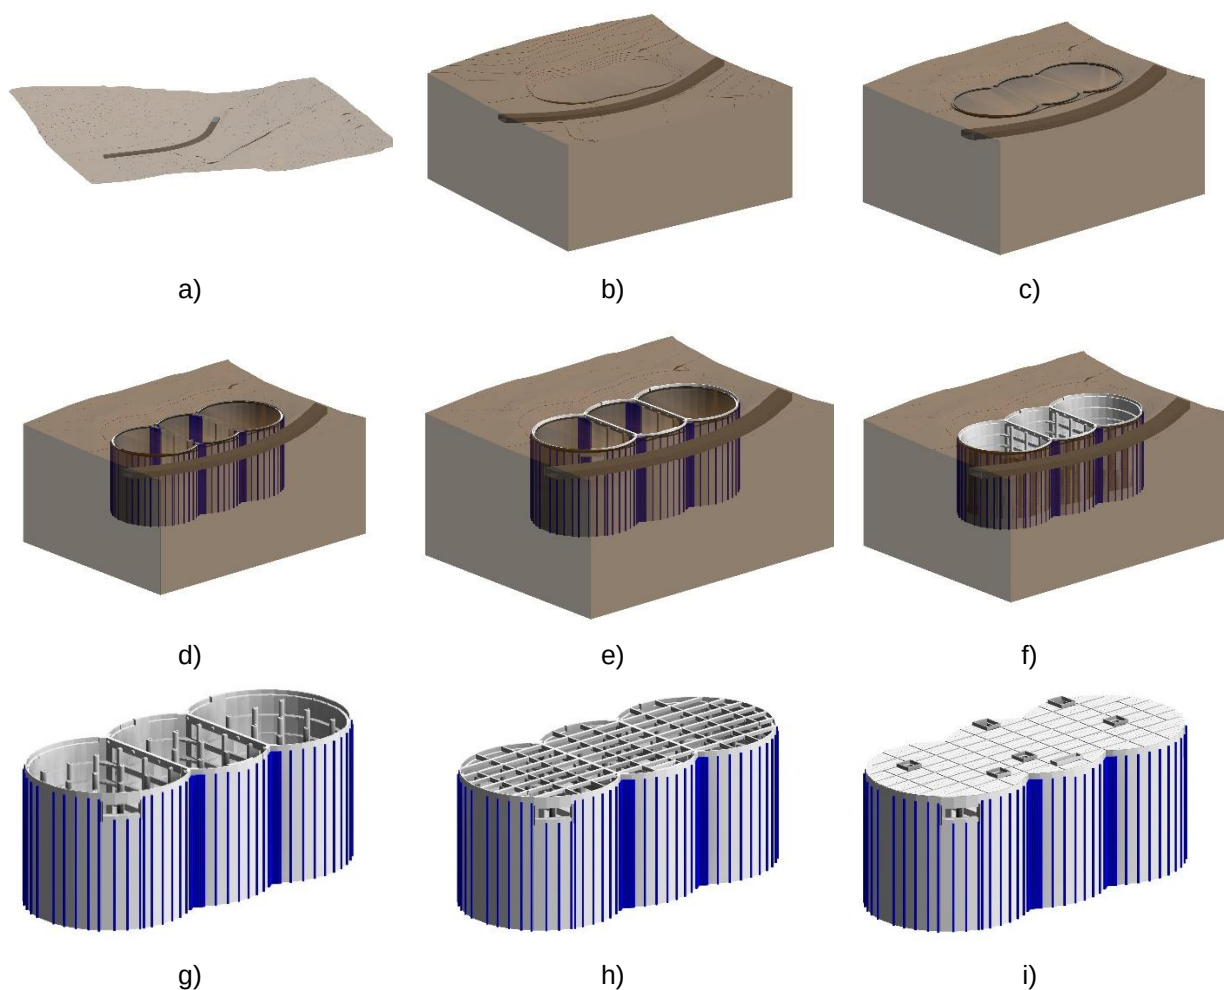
Fases para a execução da estrutura: a) existente; b) escavação; c) muro guia; d) painéis e *jet grouting*; e) viga de coroamento; f) anéis e estroncas; h) vigas de cobertura; i) lajes de cobertura.
